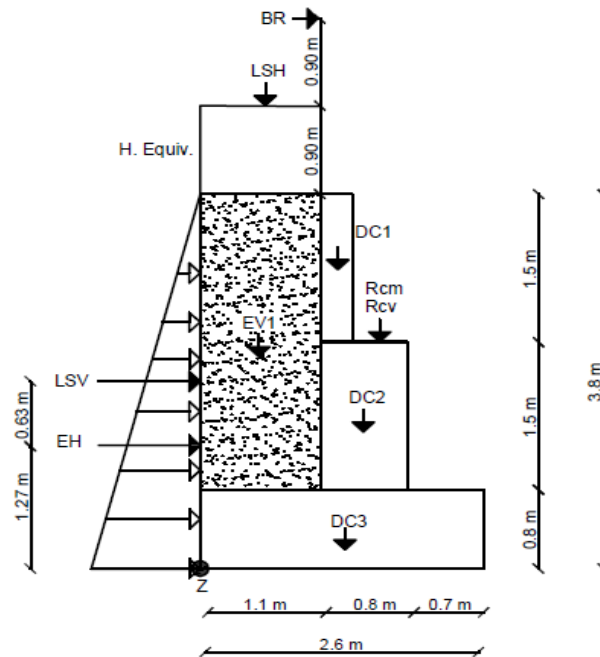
Cargas que actúan en el estribo. Elaborado por: Autor
